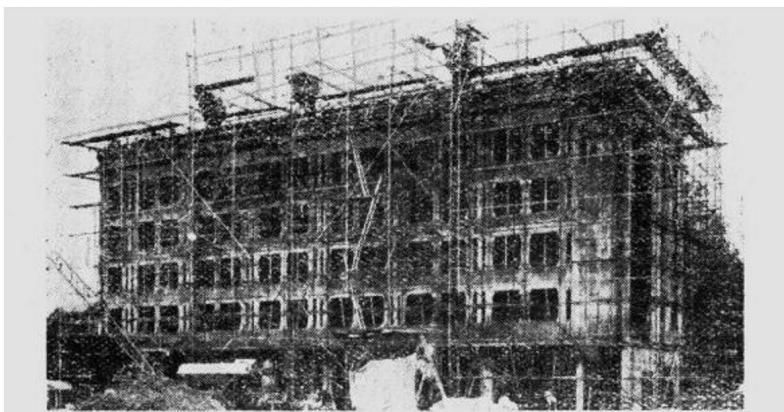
英国利用滑动模板建造的六层钢筋混凝土建筑物施工情况
